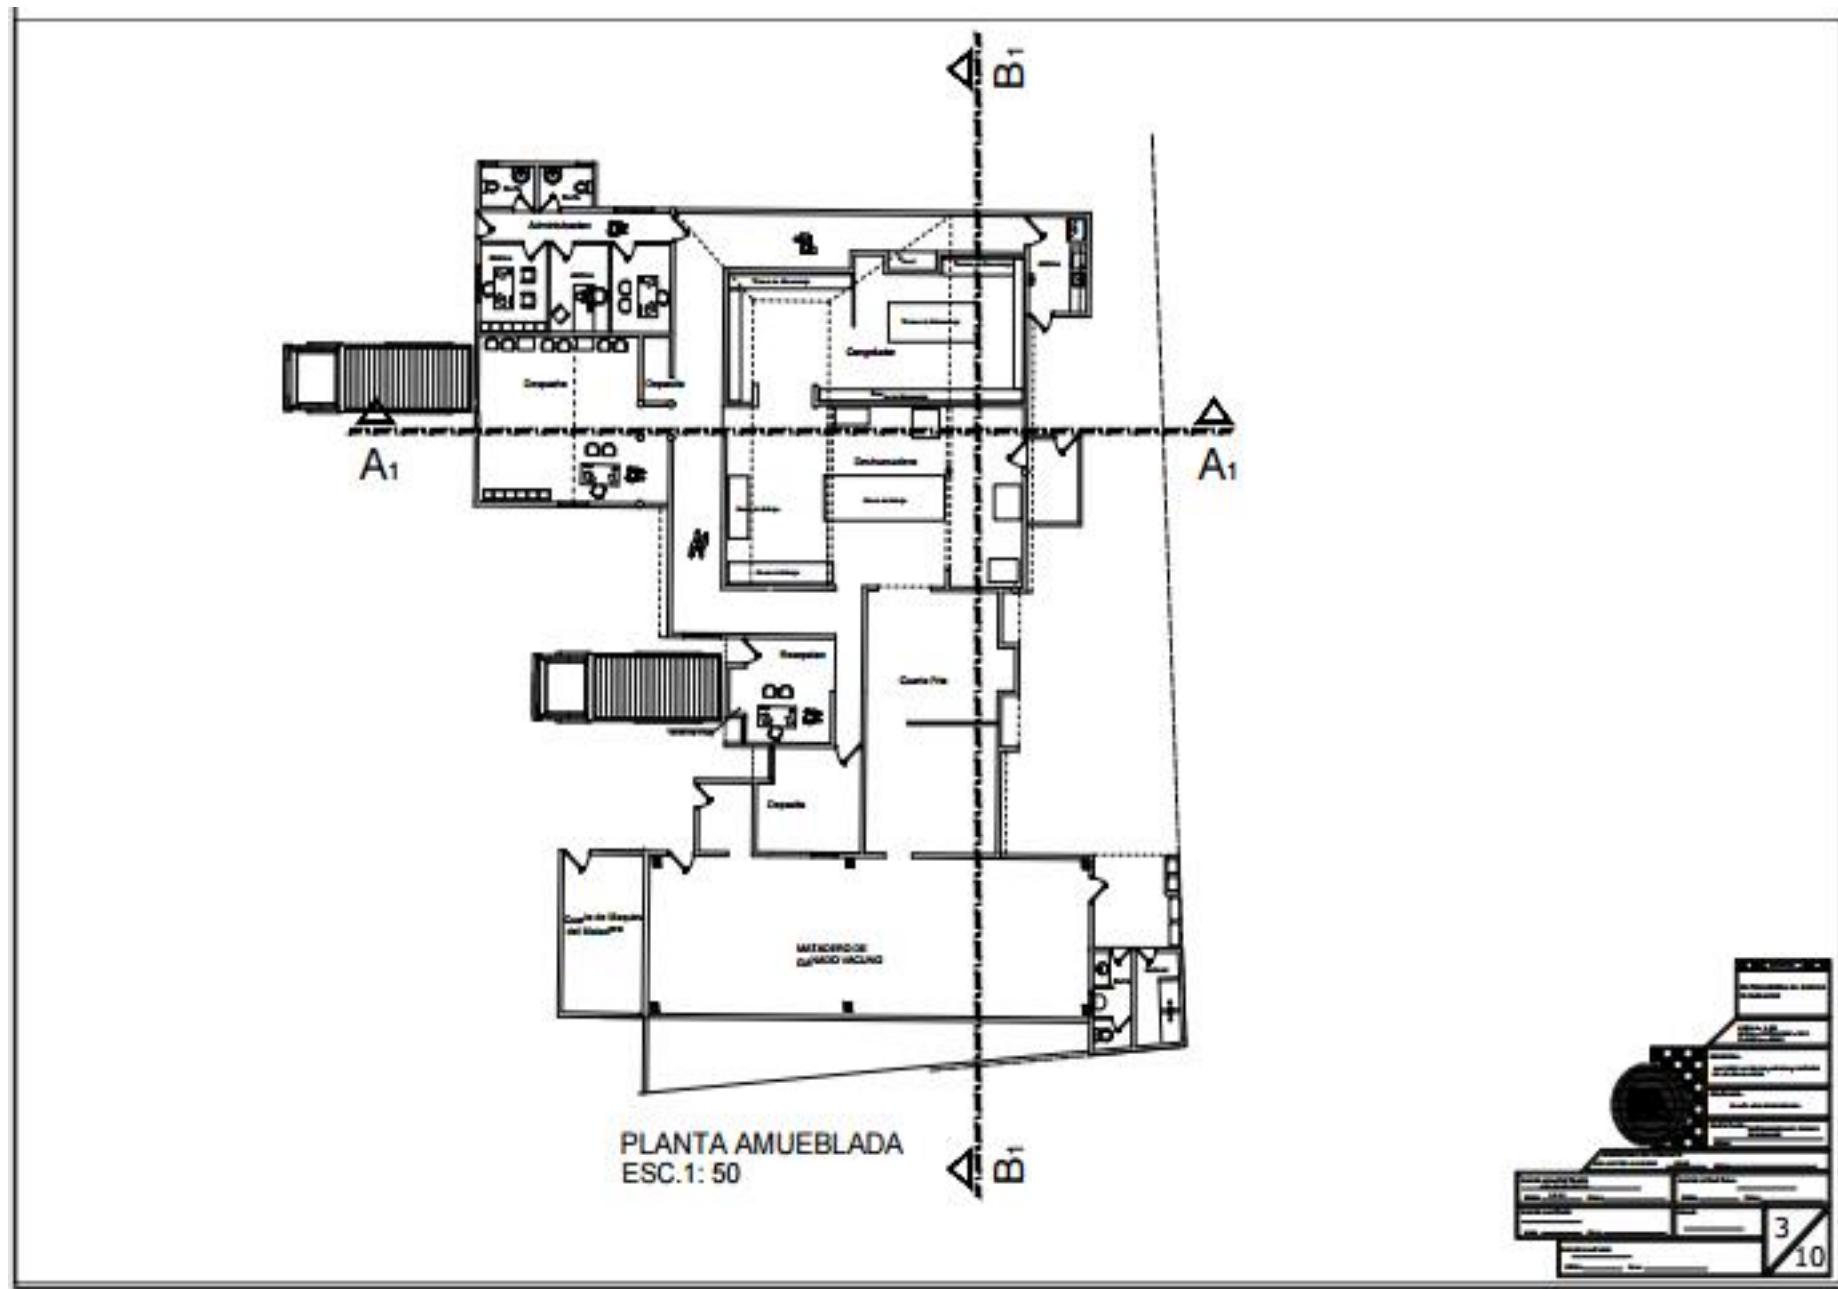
Planta amueblada. (Ver anexo no. 3)
